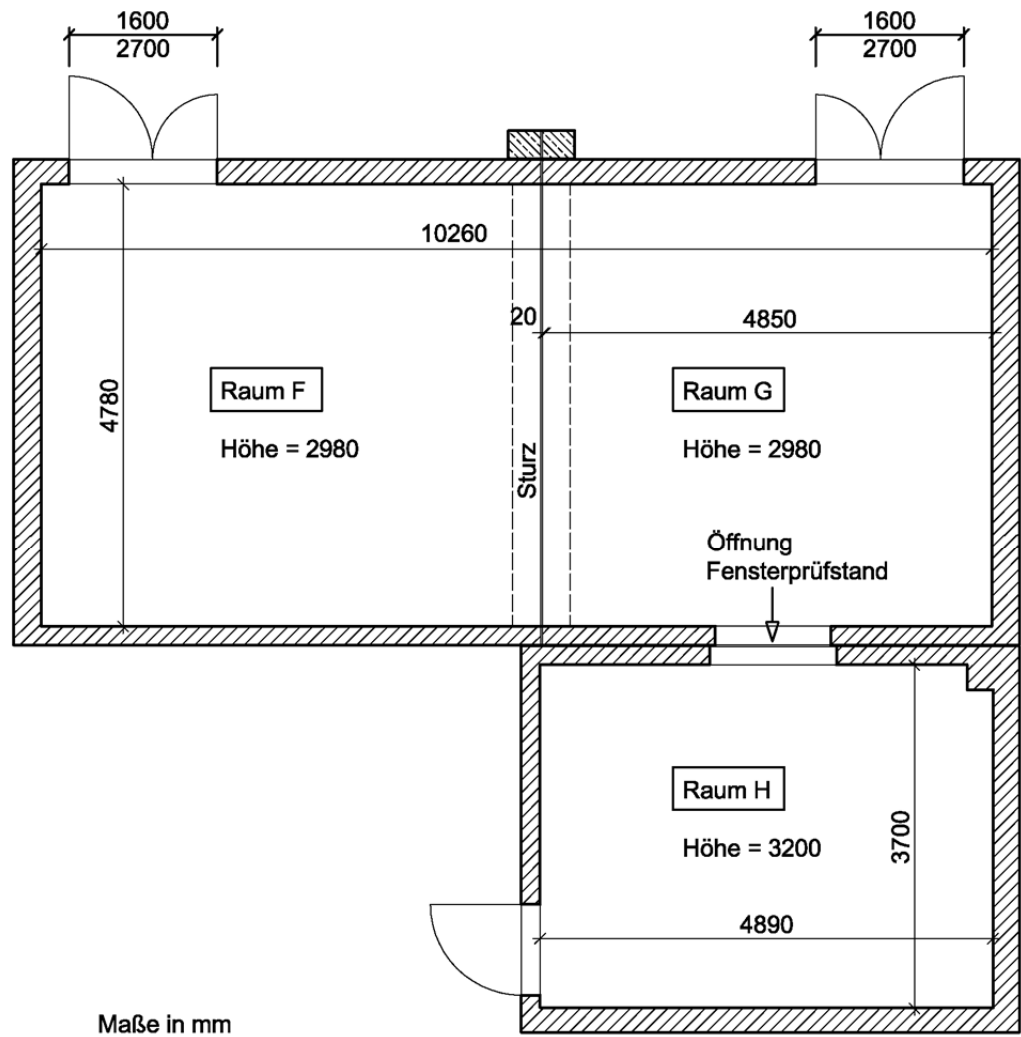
Grundriss des Fensterprüfstands.
